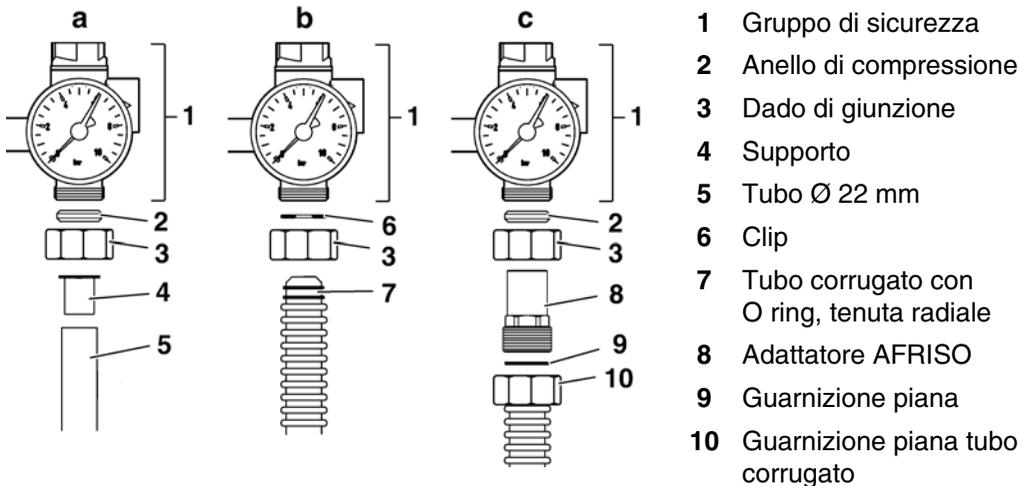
a – Tubo di connessione con fissaggio a stringere
